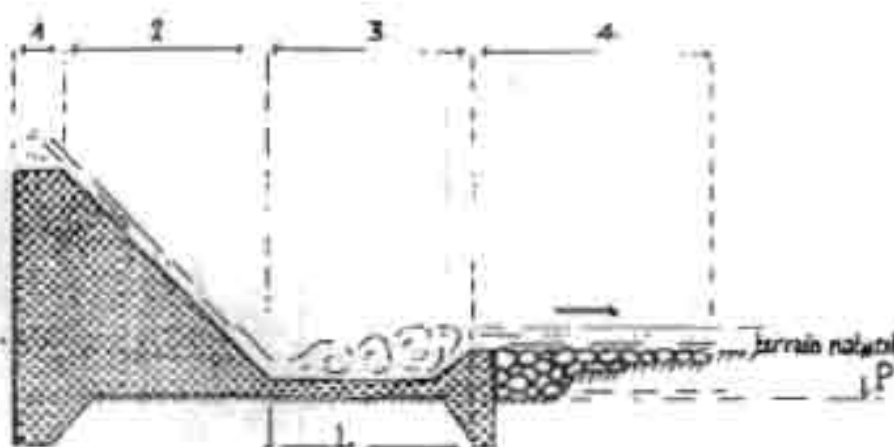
Coupe en travers d'un évacuateur de crue
